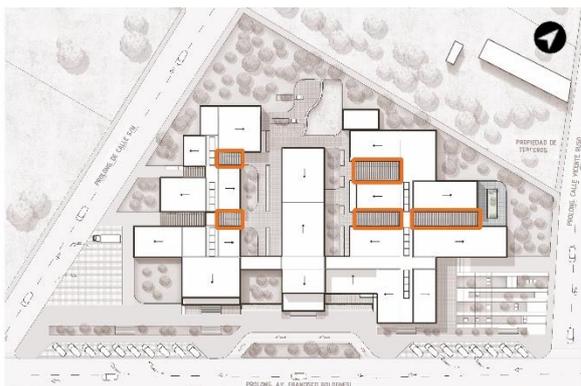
Plano de espacio 07- Zonas de descanso.
